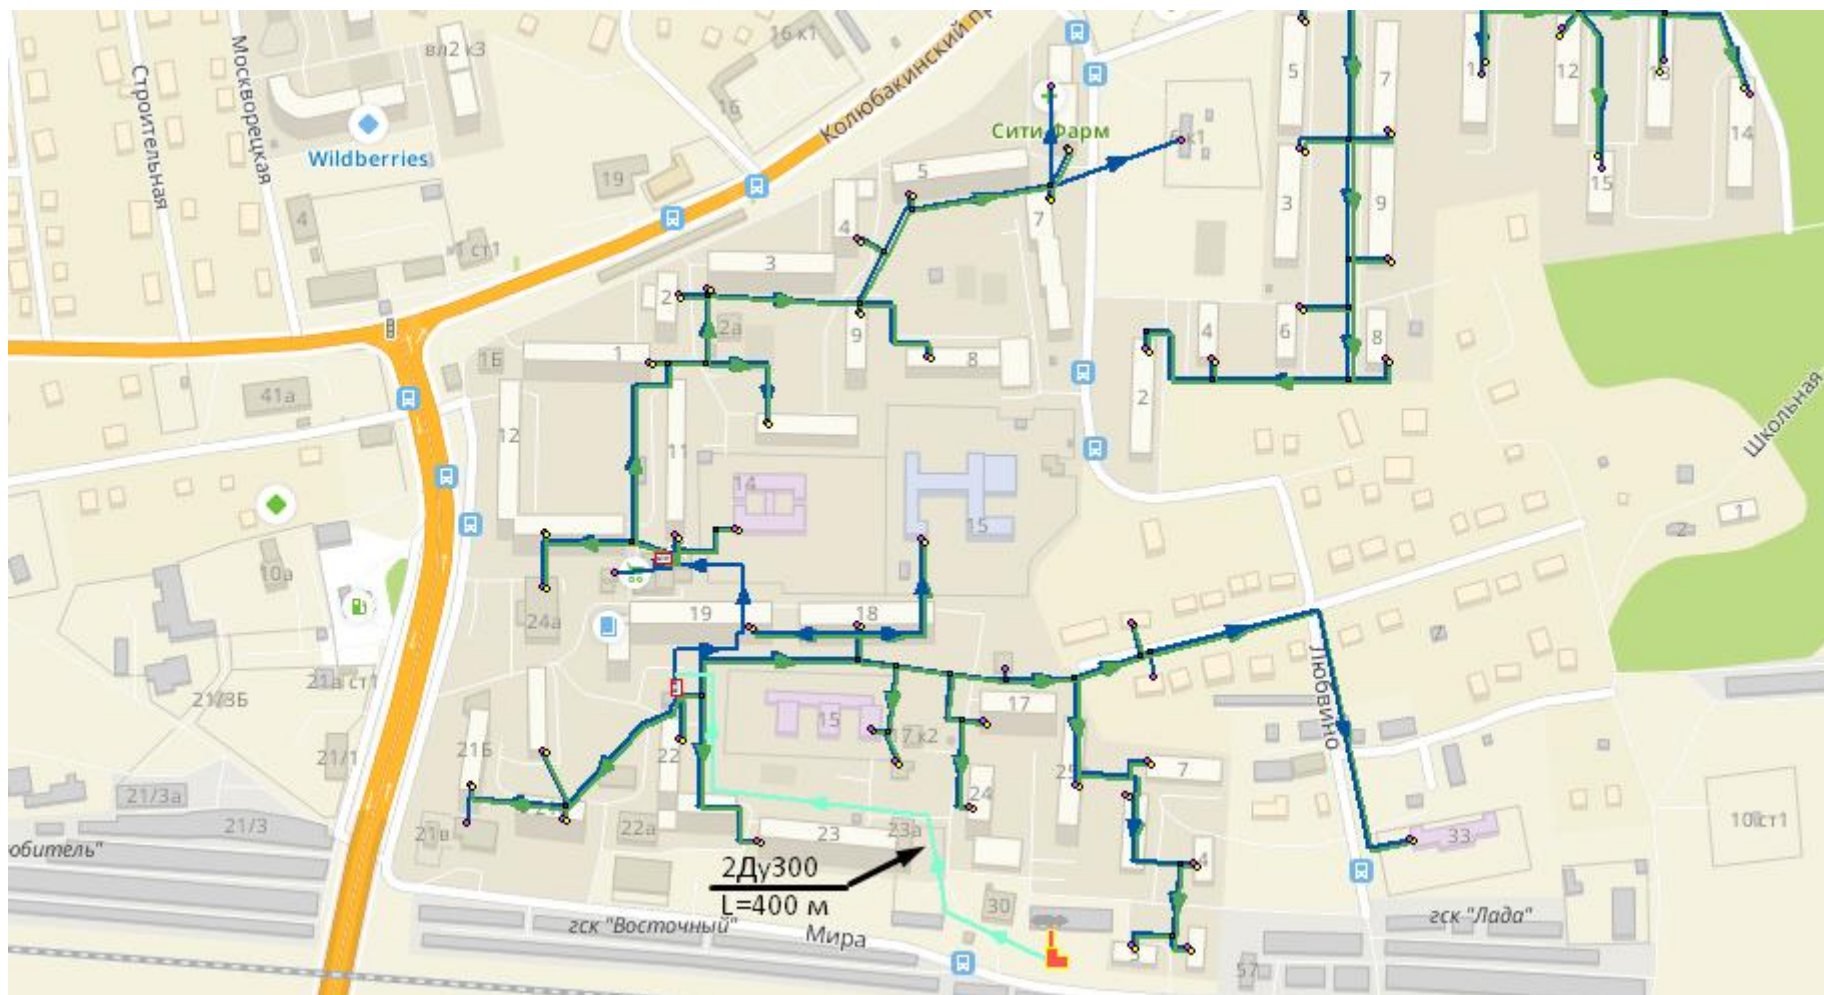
Строительство тепловых сетей для подключения тепловой нагрузки от ЦТП – 4 и ЦТП-5 котельной ул. Партизан 47 к БМК п. Тучково, Восточный мкр.
